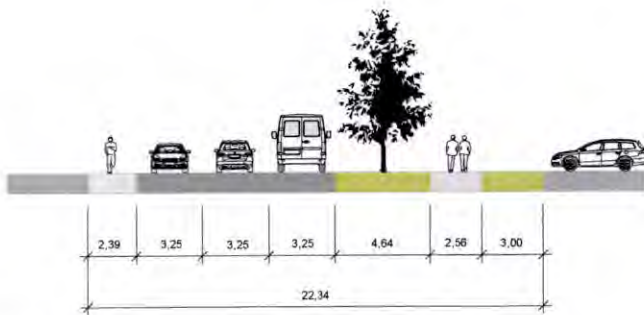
Straßenquerschnitt Konsul-Rühmann-Straße
